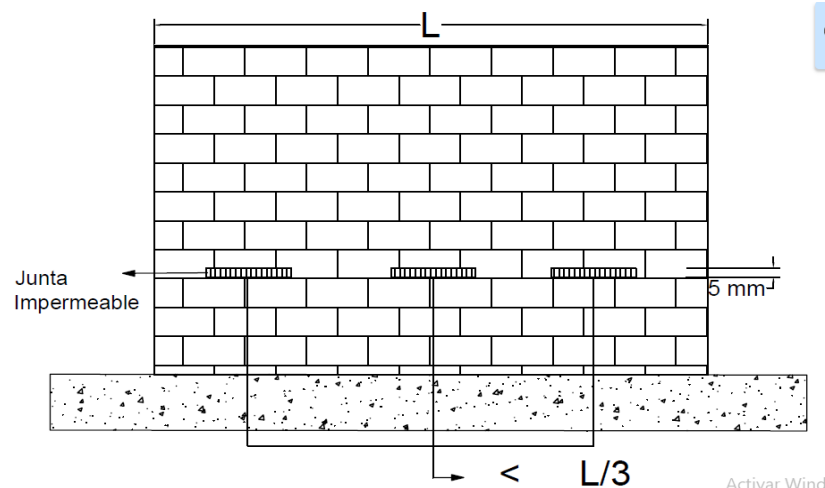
Ubicación de Juntas Impermeables en Muros.
